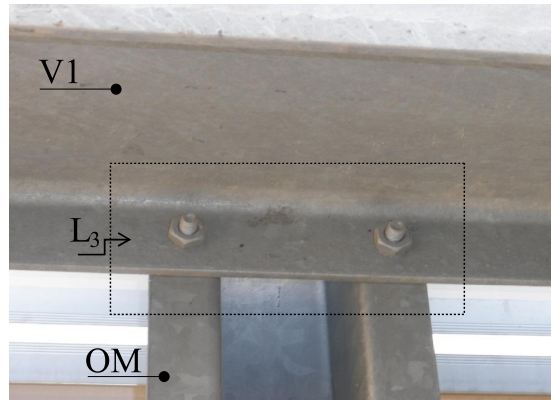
Ligação L_3 entre um perfil OM e a viga V1.
